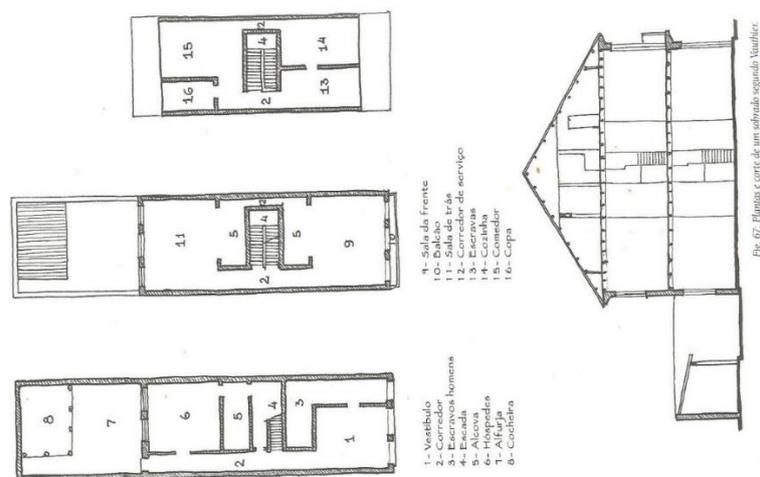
Planta baixa e corte de um sobrado segundo Vauthier.
